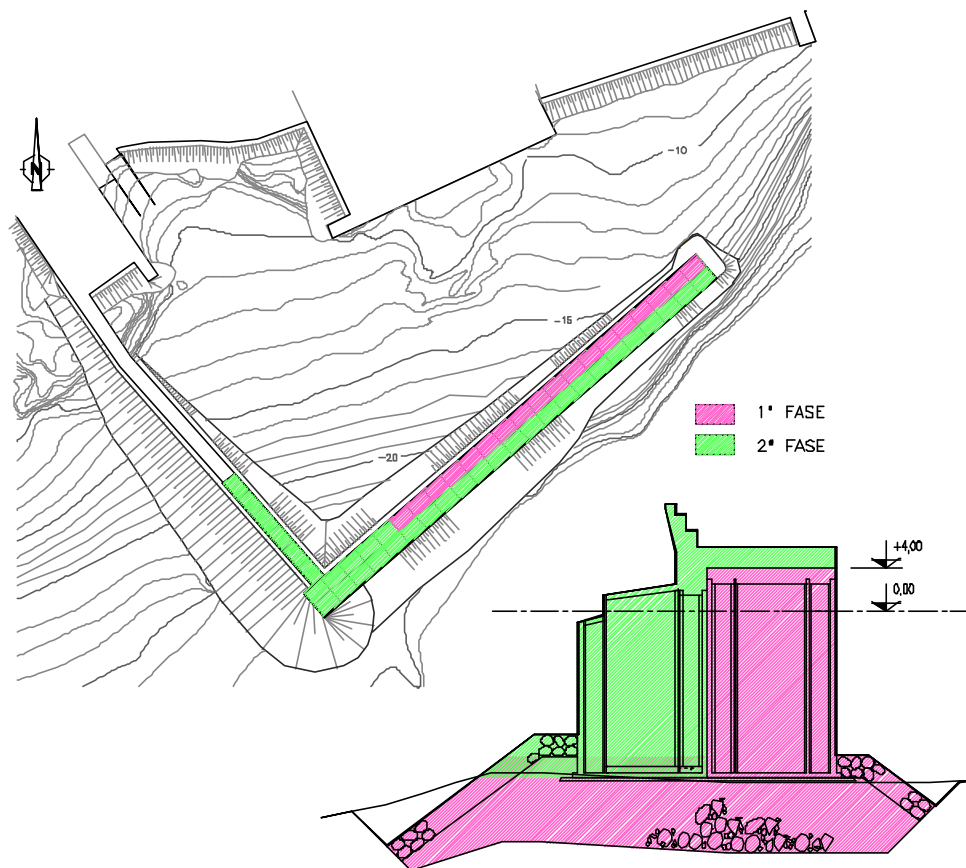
Faseamento da Obra. Planta e Perfis Tipo
